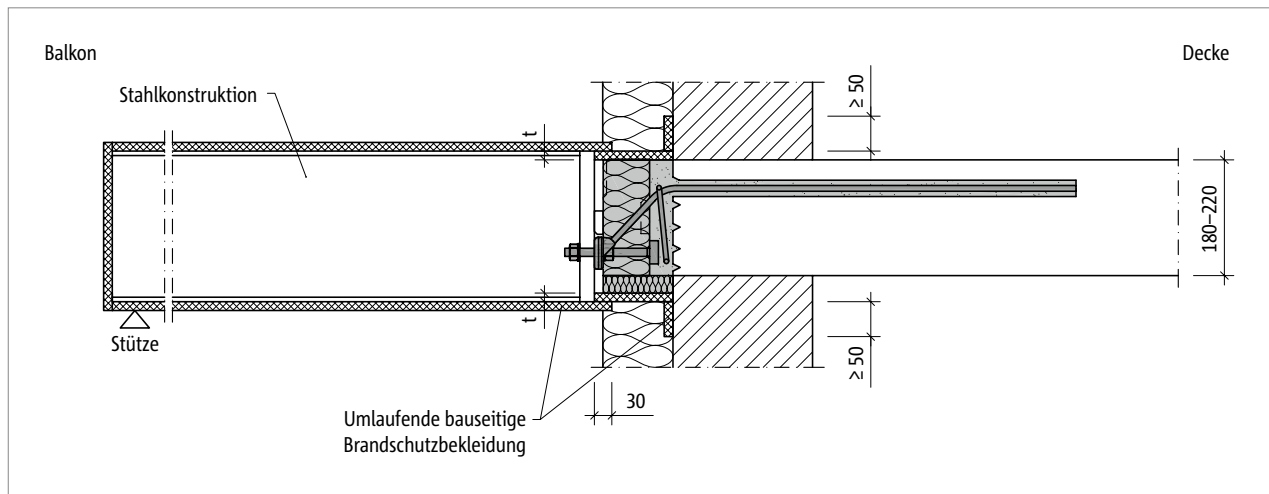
Schöck Isokorb® RT Typ SQ: Bauseitige Brandschutzbekleidung RT Typ SQ und Stahlkonstruktion; Schnitt
